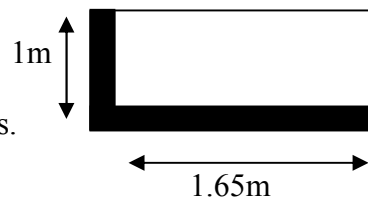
Schéma de ferrailage de la dalle sur seule appuis.
